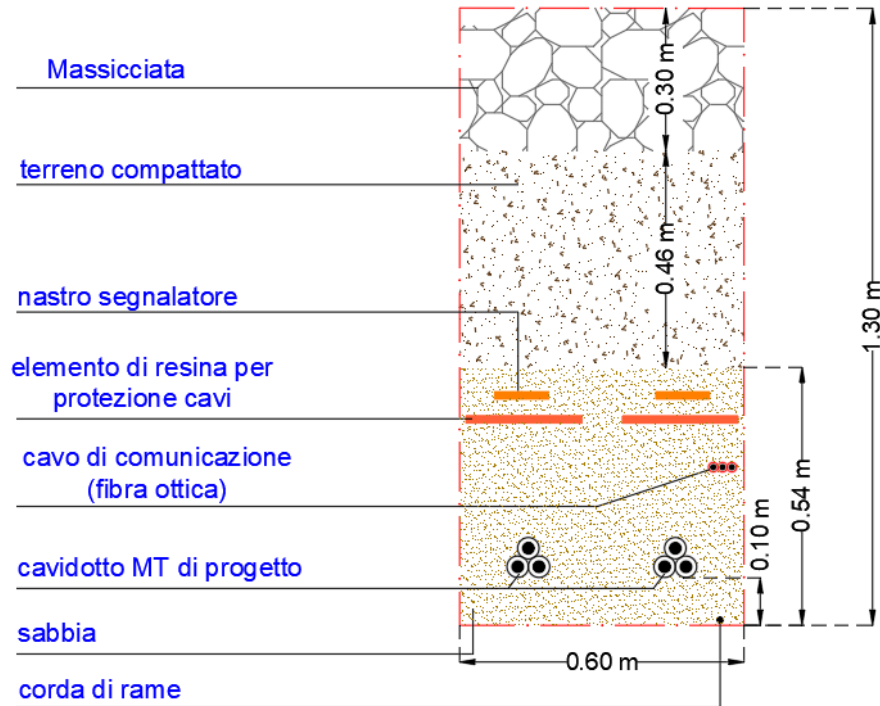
Sezione Cavidotto Doppia Terna su Strada Bianca
